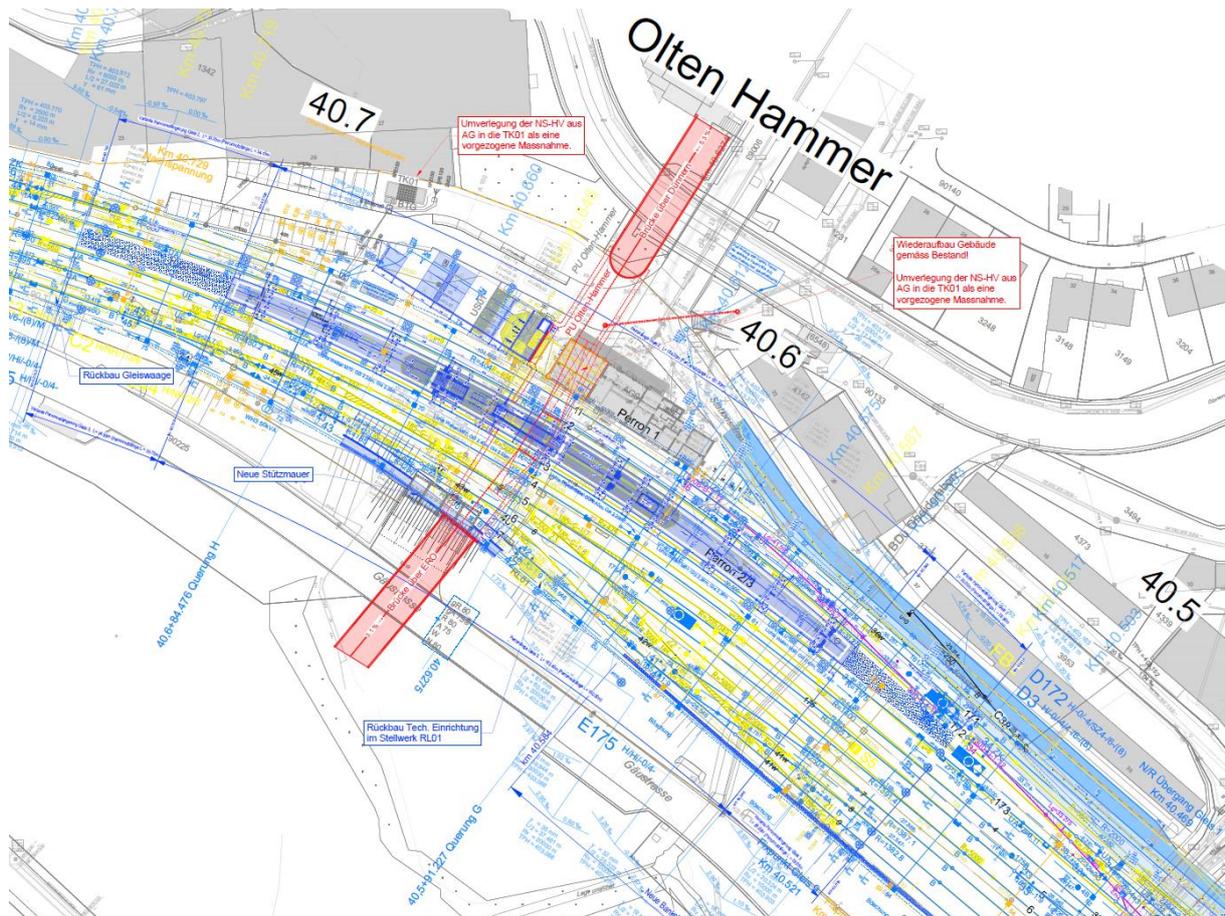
Ausschnitt aus dem Koordinationsplan: StvH (rot), Substanzerhalt Olten Hammer SBB (blau)
